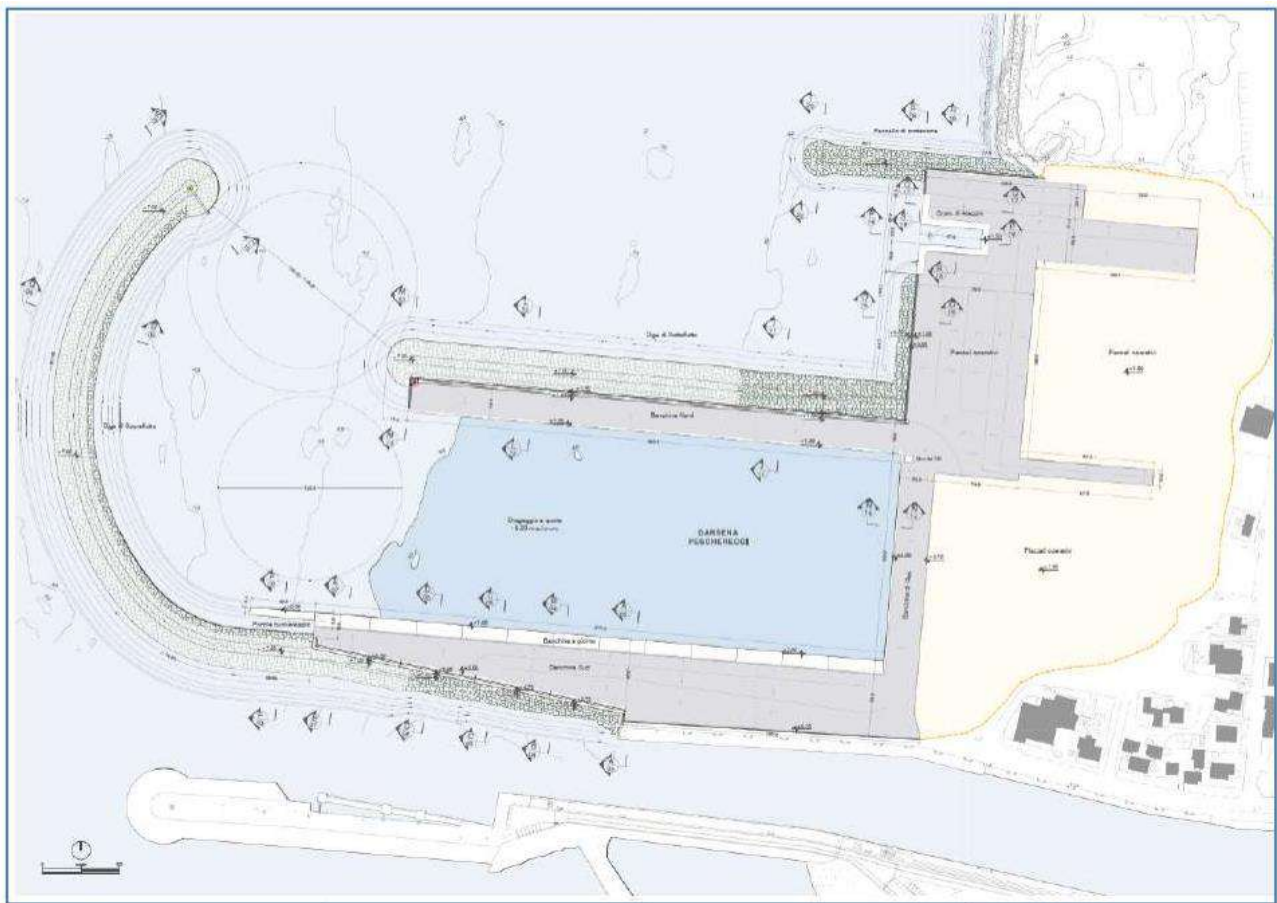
Darsena Pescherecci. Planimetria generale di intervento (Elab. EG.OM.01)
